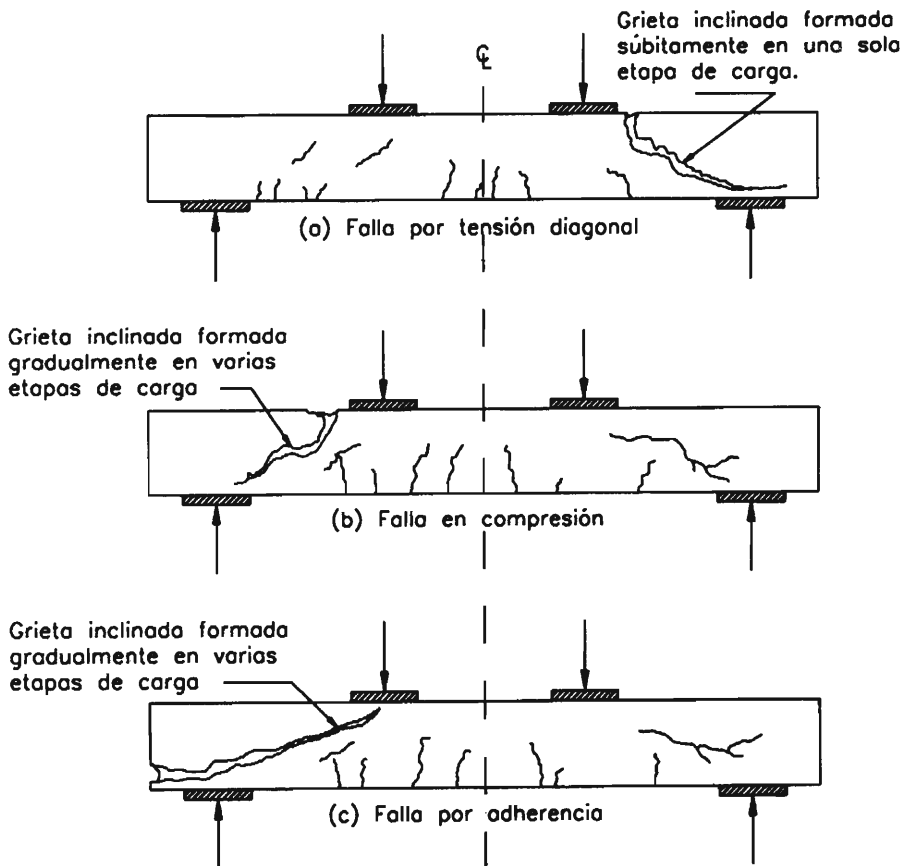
Patrón de fisuras para vigas de concreto con diferentes esbelteces
